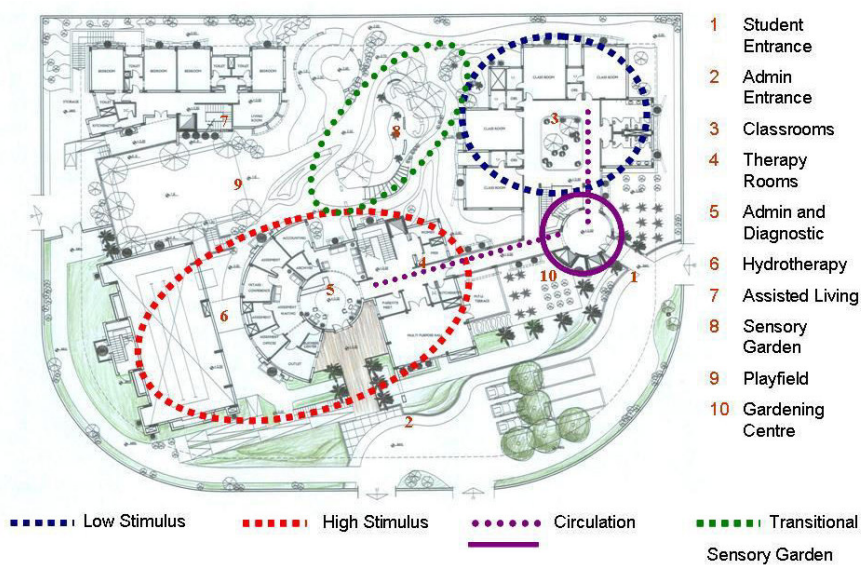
8 - Planta do Piso Térreo - Advanced Center of Autism
